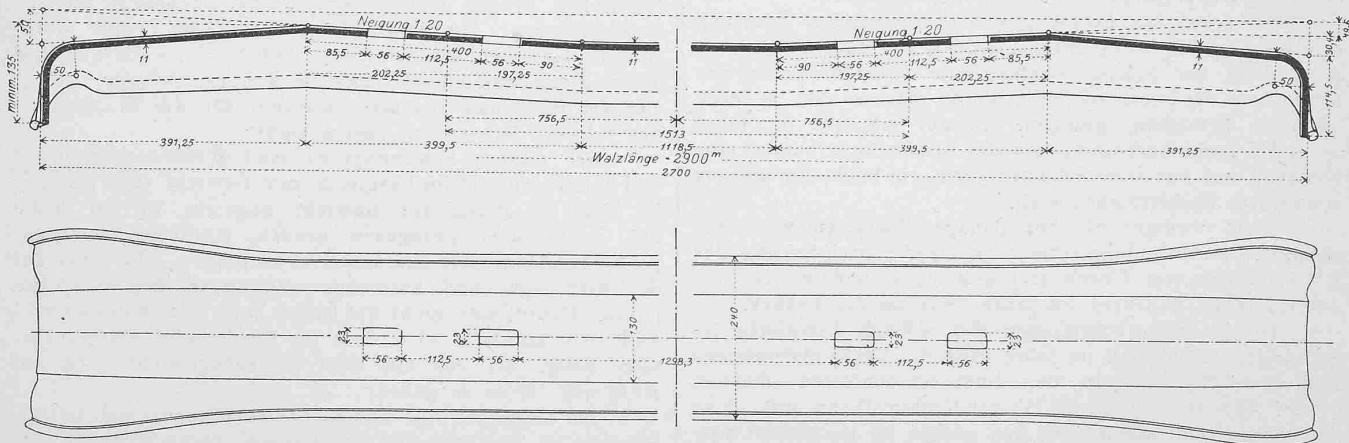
Eiserne Querschwelle. — Grundriss und Längsschnitt. — Masstab 1:10.
